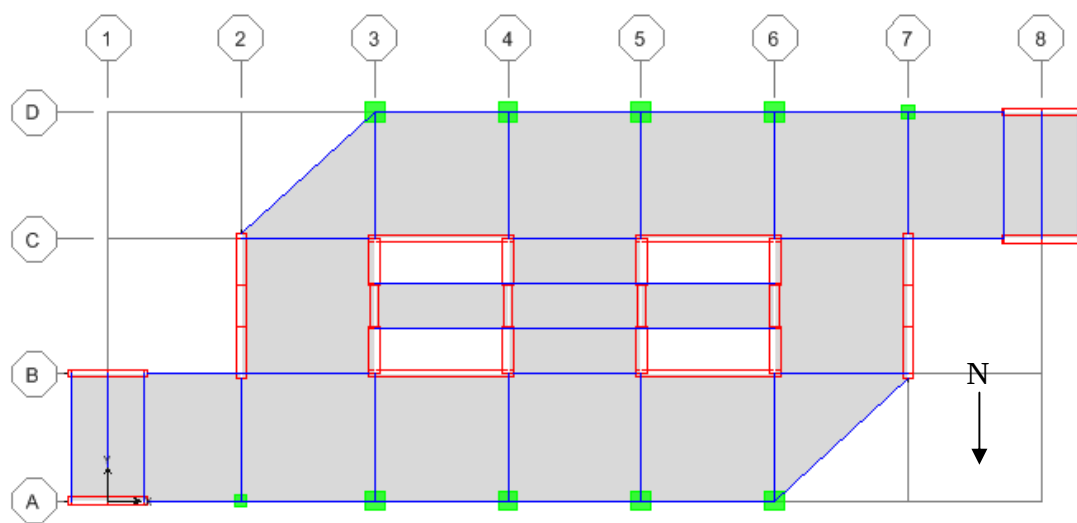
Planta Tipo Trapezoidal. Torre Banap
